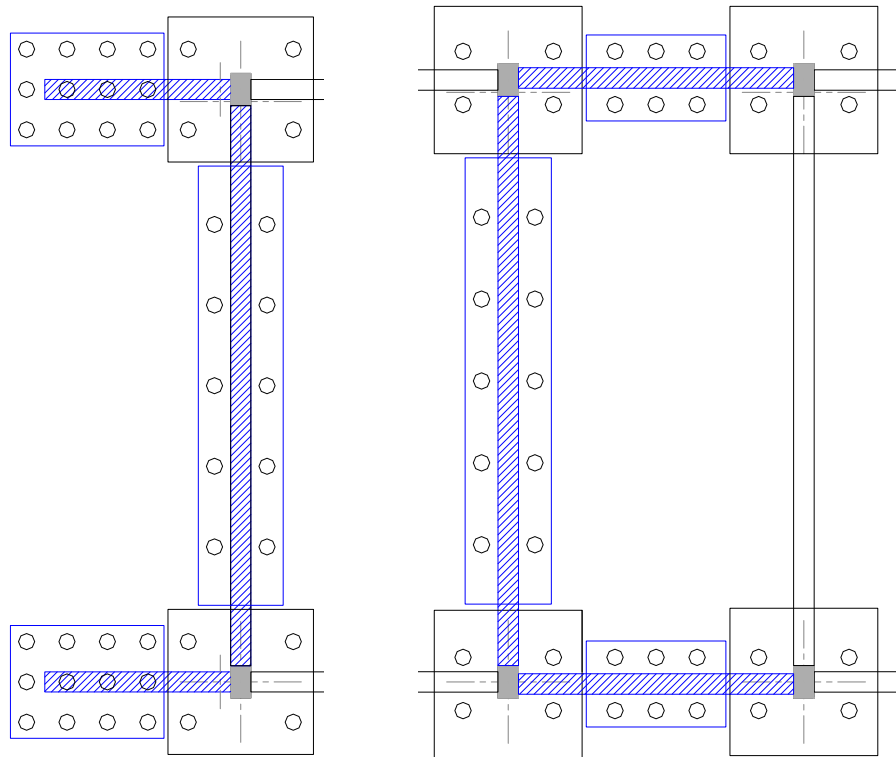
Detalle del Refuerzo Tipo 1 y Tipo 2 muy similar.
